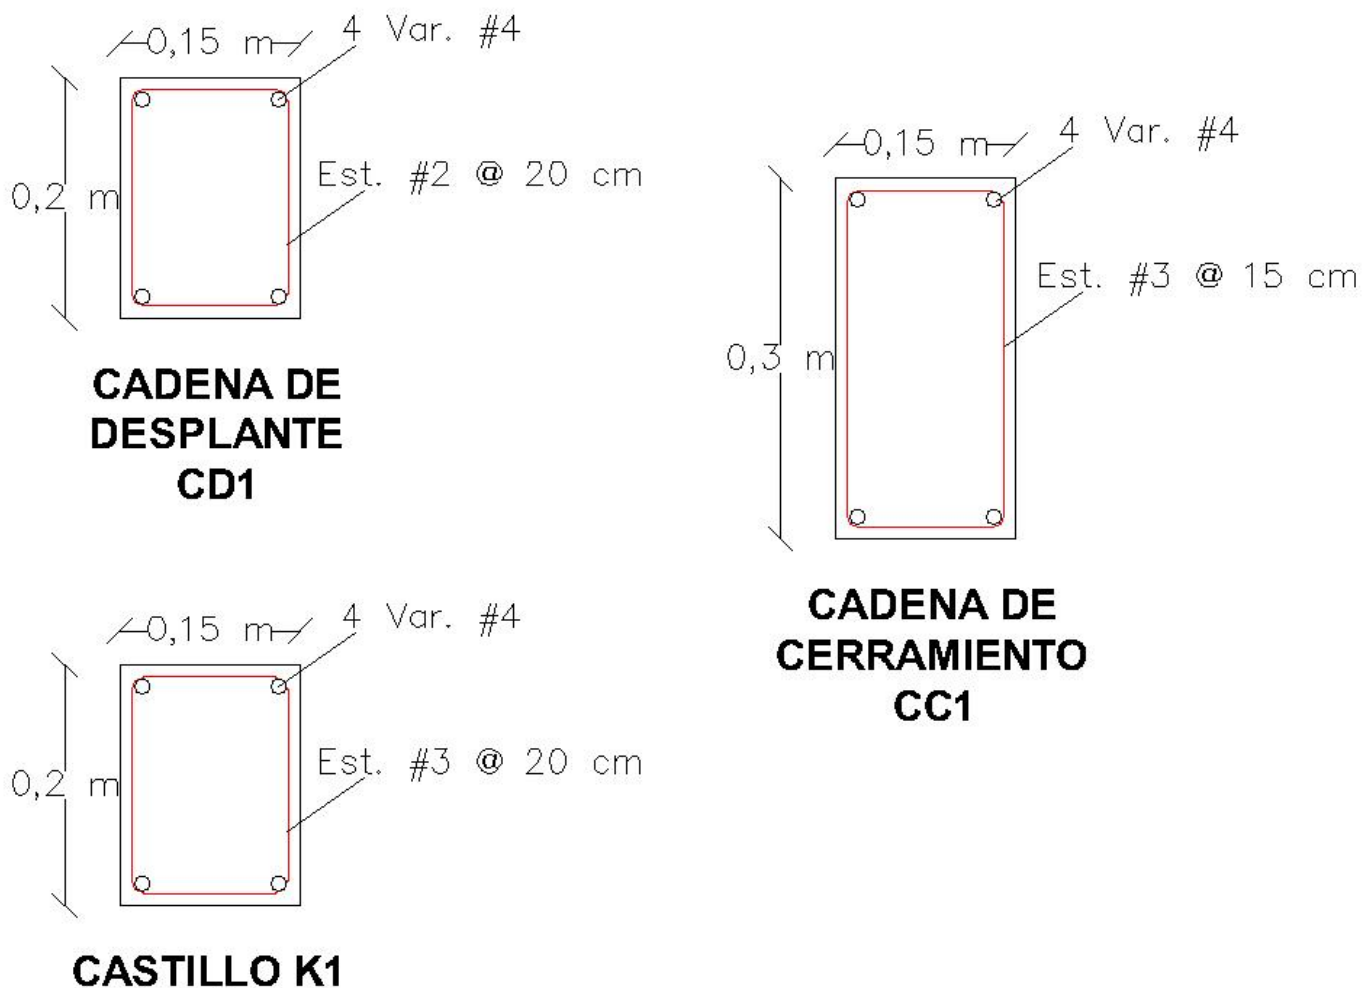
Detalles constructivos de cadenas y cerramientos. (Fuente: Propia).
